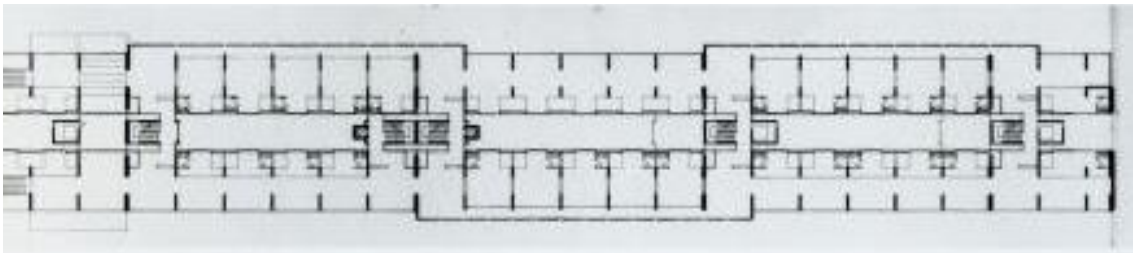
Stralcio di pianta del piano libero (ArchiDiap)
